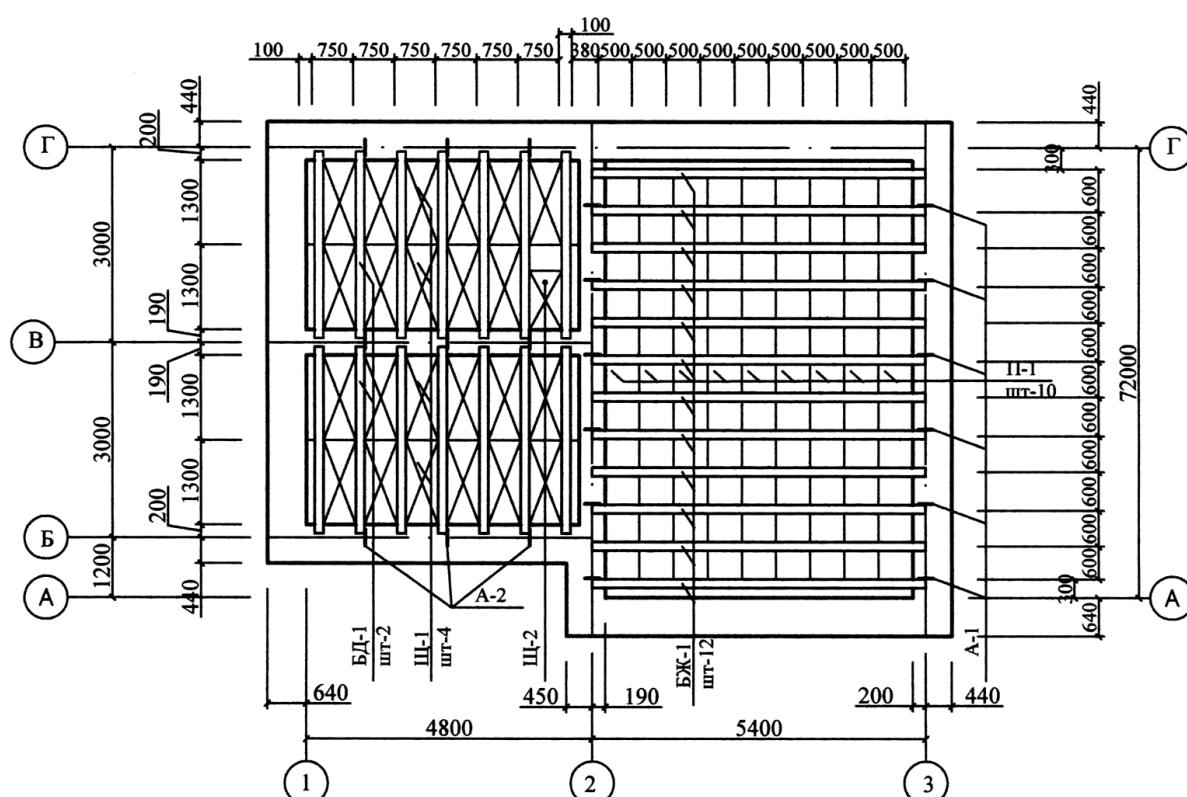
План перекрытия по деревянным и железобетонным балкам (БД – балка деревянная, БЖ – балка железобетонная, Щ – щит наката, П – плита, А – анкеры)
